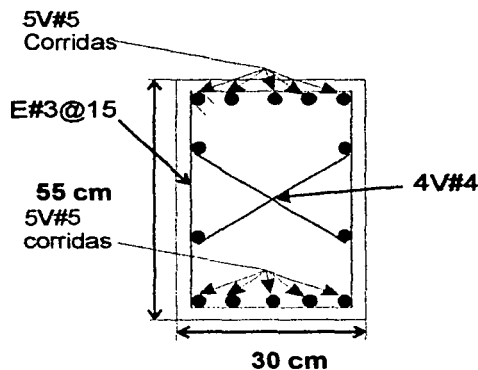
Detalle de armado y de geometría de trabe T1E
